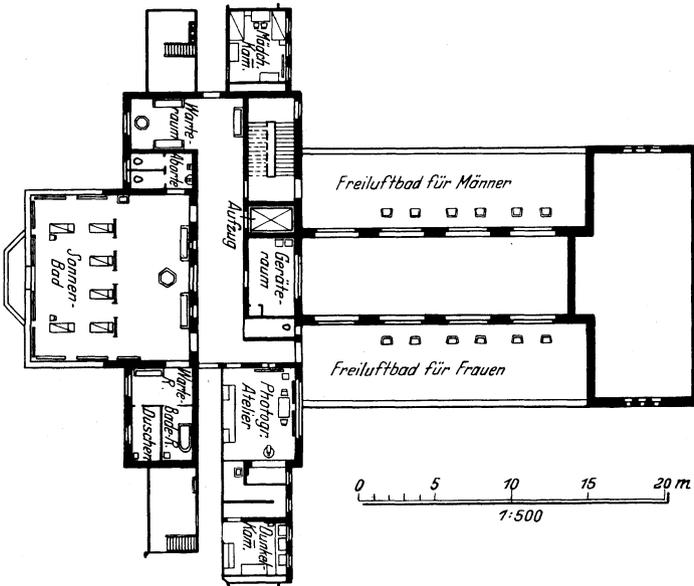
München-Schwabing, städt. Krankenhaus, Licht- und Sonnenbad.
